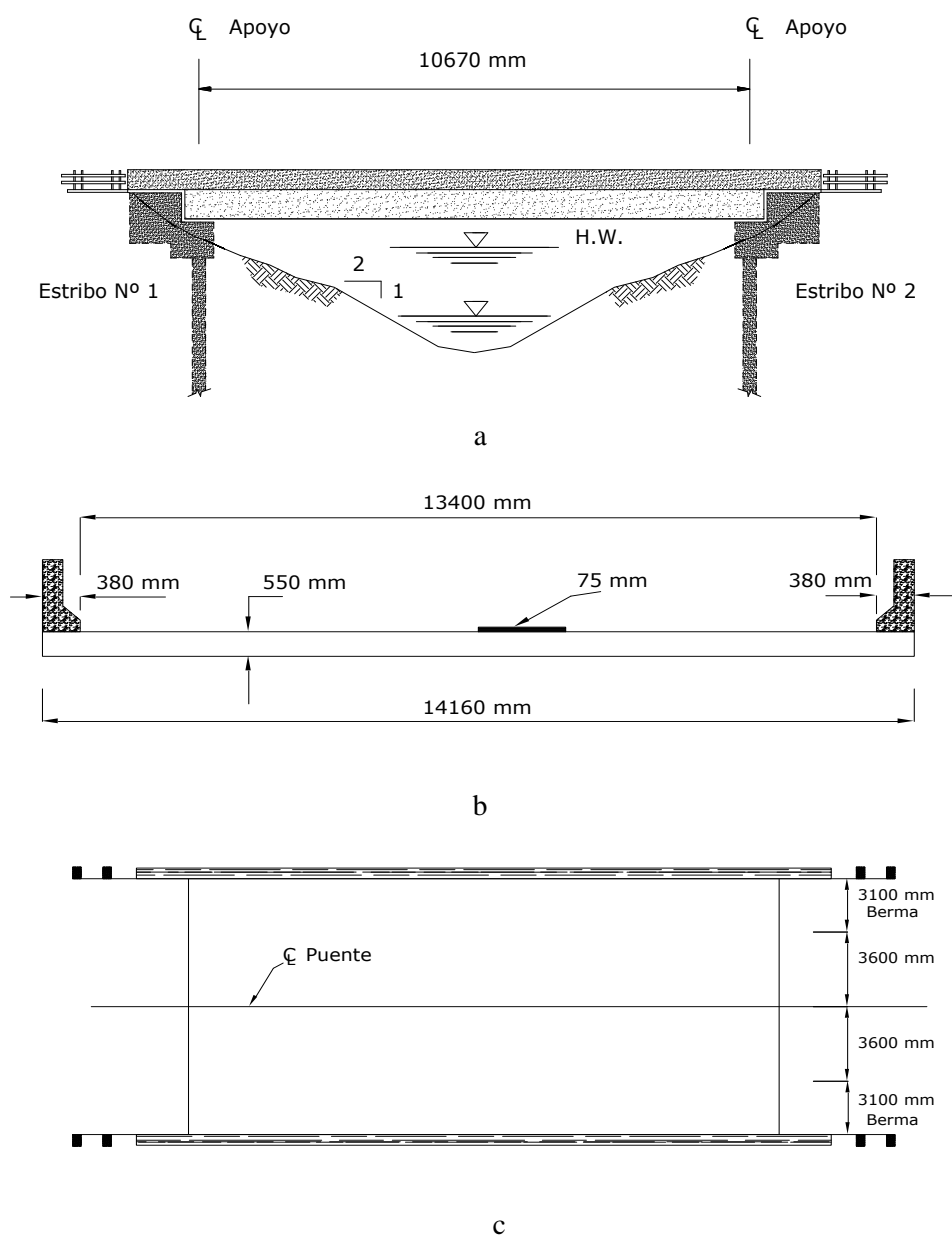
(a) Sección longitudinal del Puente Losa, (b) Sección Transversal, (c). Vista en planta
